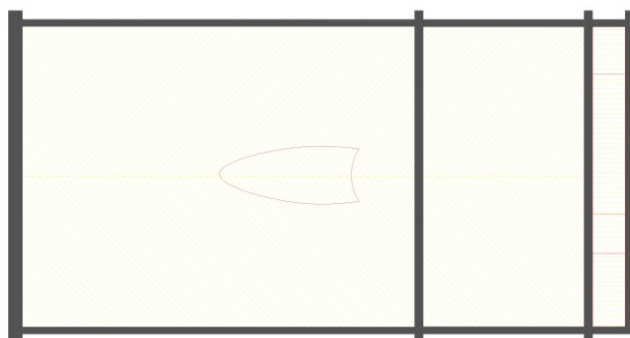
Planta proposta Cobertura Fonte: Autor(es)
